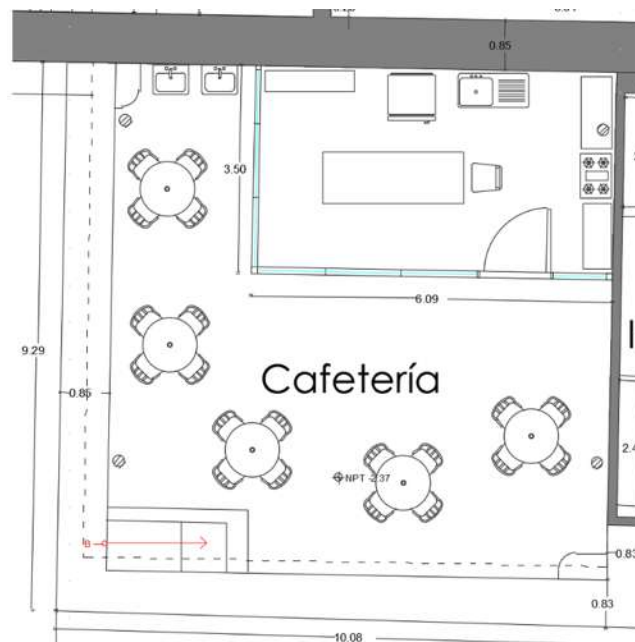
Estado actual de la cafetería, plano elaboración propia.
